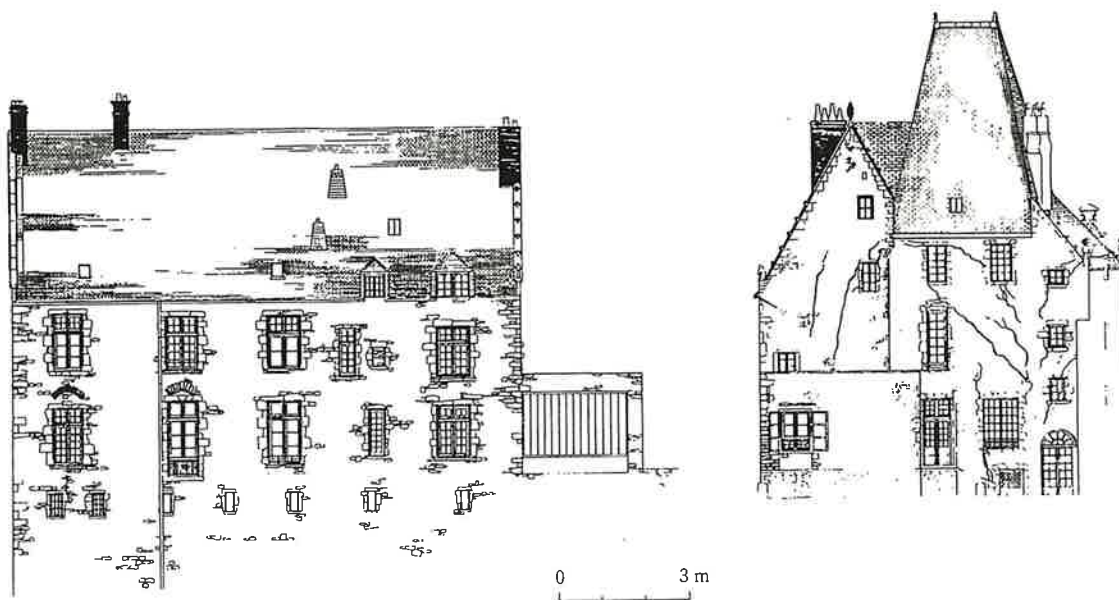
Façade sur la Sarthe et façade sur jardin avant travaux, en 1989
